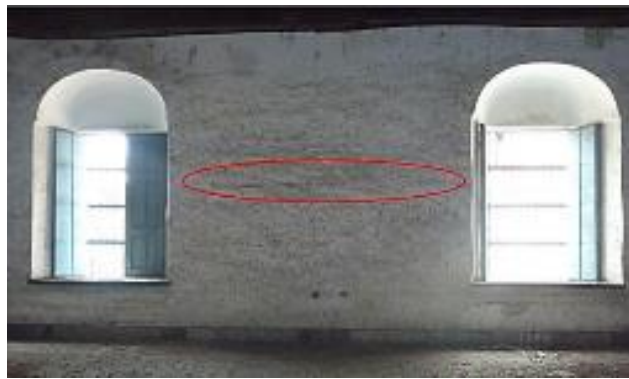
Fissuras horizontais na parte inferior da parede (eixo 1).
